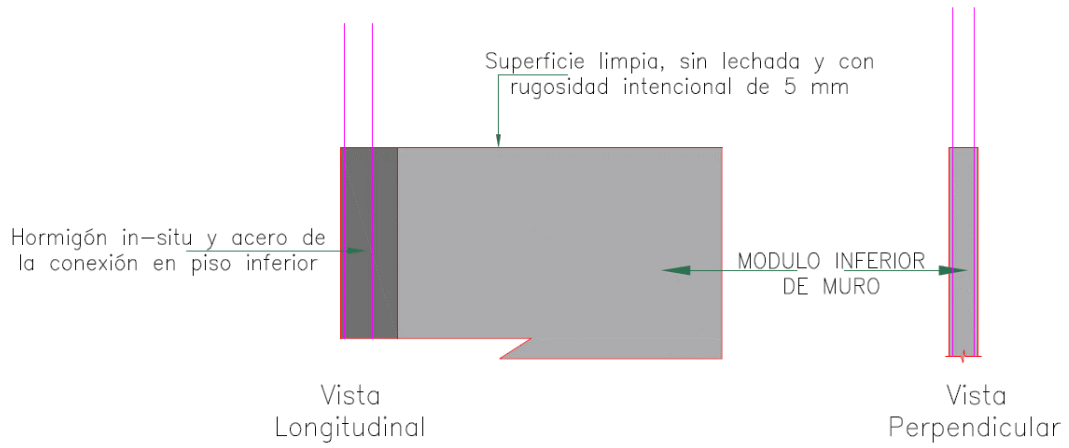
Detalles de conexiones con zonas construidas in-situ
